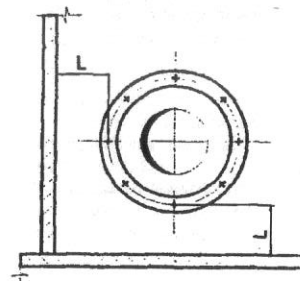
Схема размещения сальников непосредственно у стен и пола помещений
